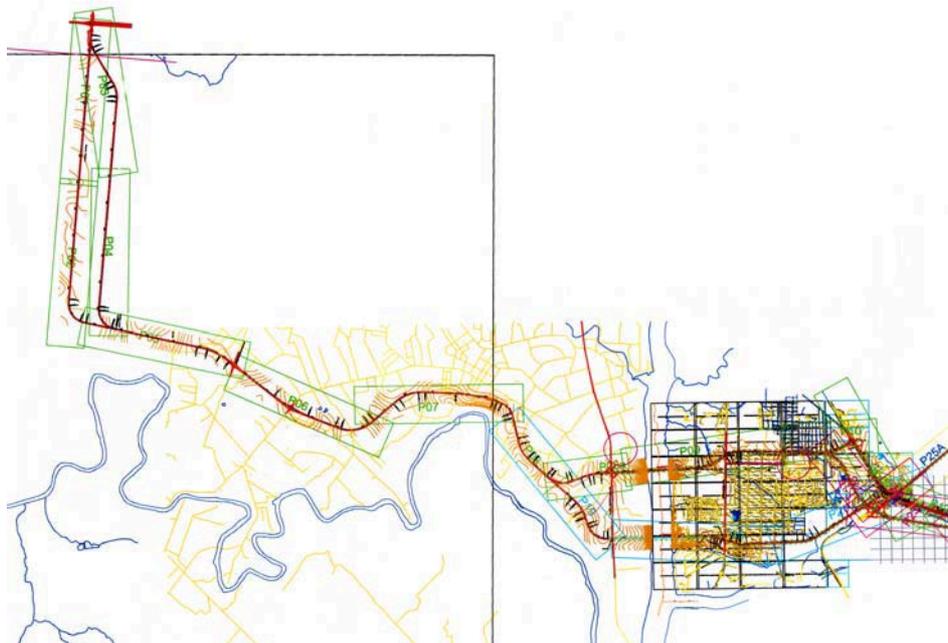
Proyecto de Construcción de Segundo Puente con Brasil
